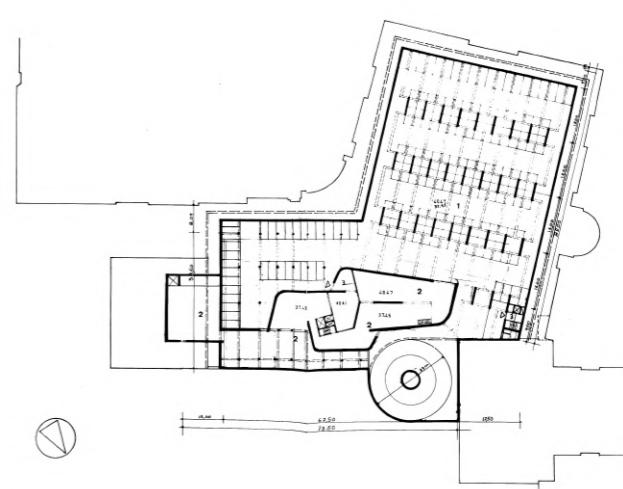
Plan d'un niveau de parking, avant-projet amendé du musée signal.
